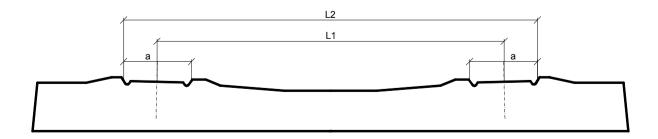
Железобетонная шпала со скреплением Vossloh
